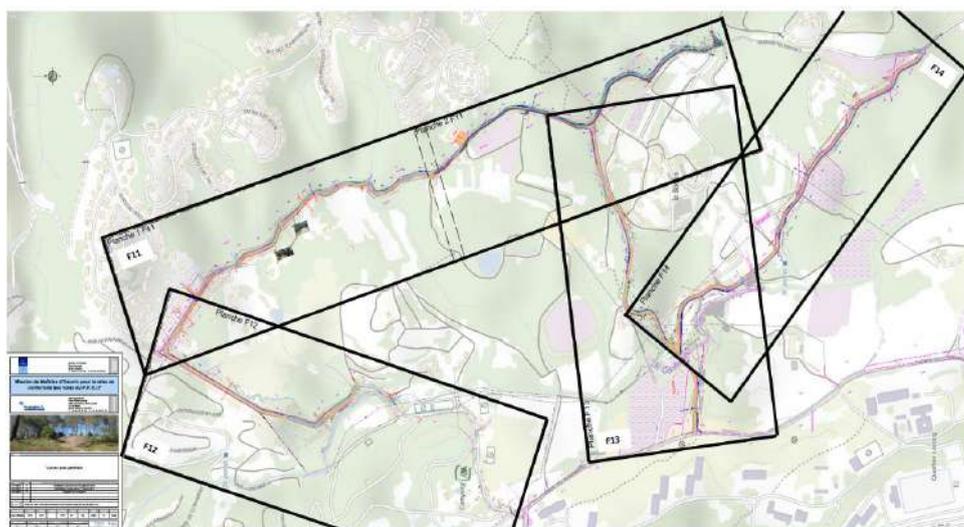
Localisation des pistes et découpage en planches (source : TPF ingénierie)
